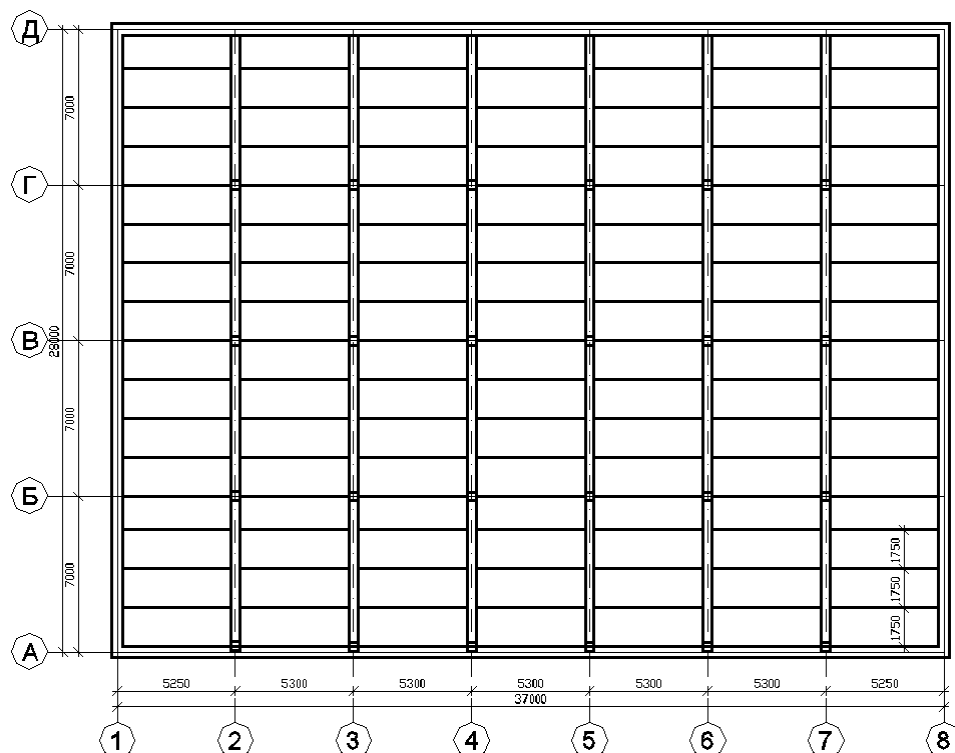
Вариант 1 компоновки монолитного междуэтажного перекрытия
